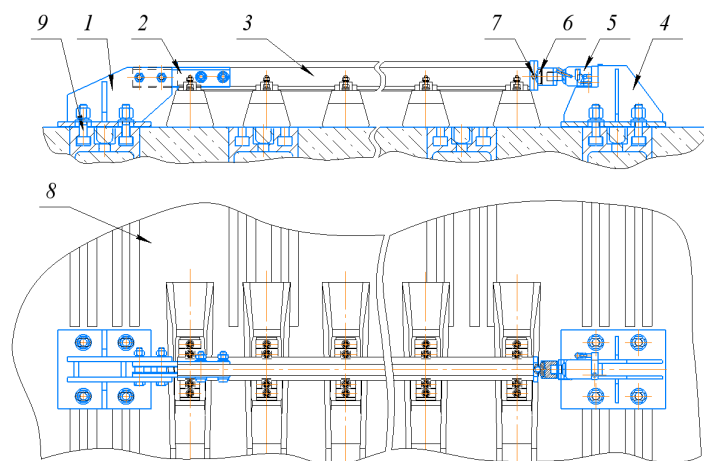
Схема стенда для испытаний рельсошпальной решетки на сжатие: 1 – кронштейн; 2 – соединительная планка; 3 – рельсошпальная решетка; 4 – упор; 5 – домкрат; 6 – датчик силы; 7 – шарик; 8 – поверхность пола; 9 – болты крепления стенда
